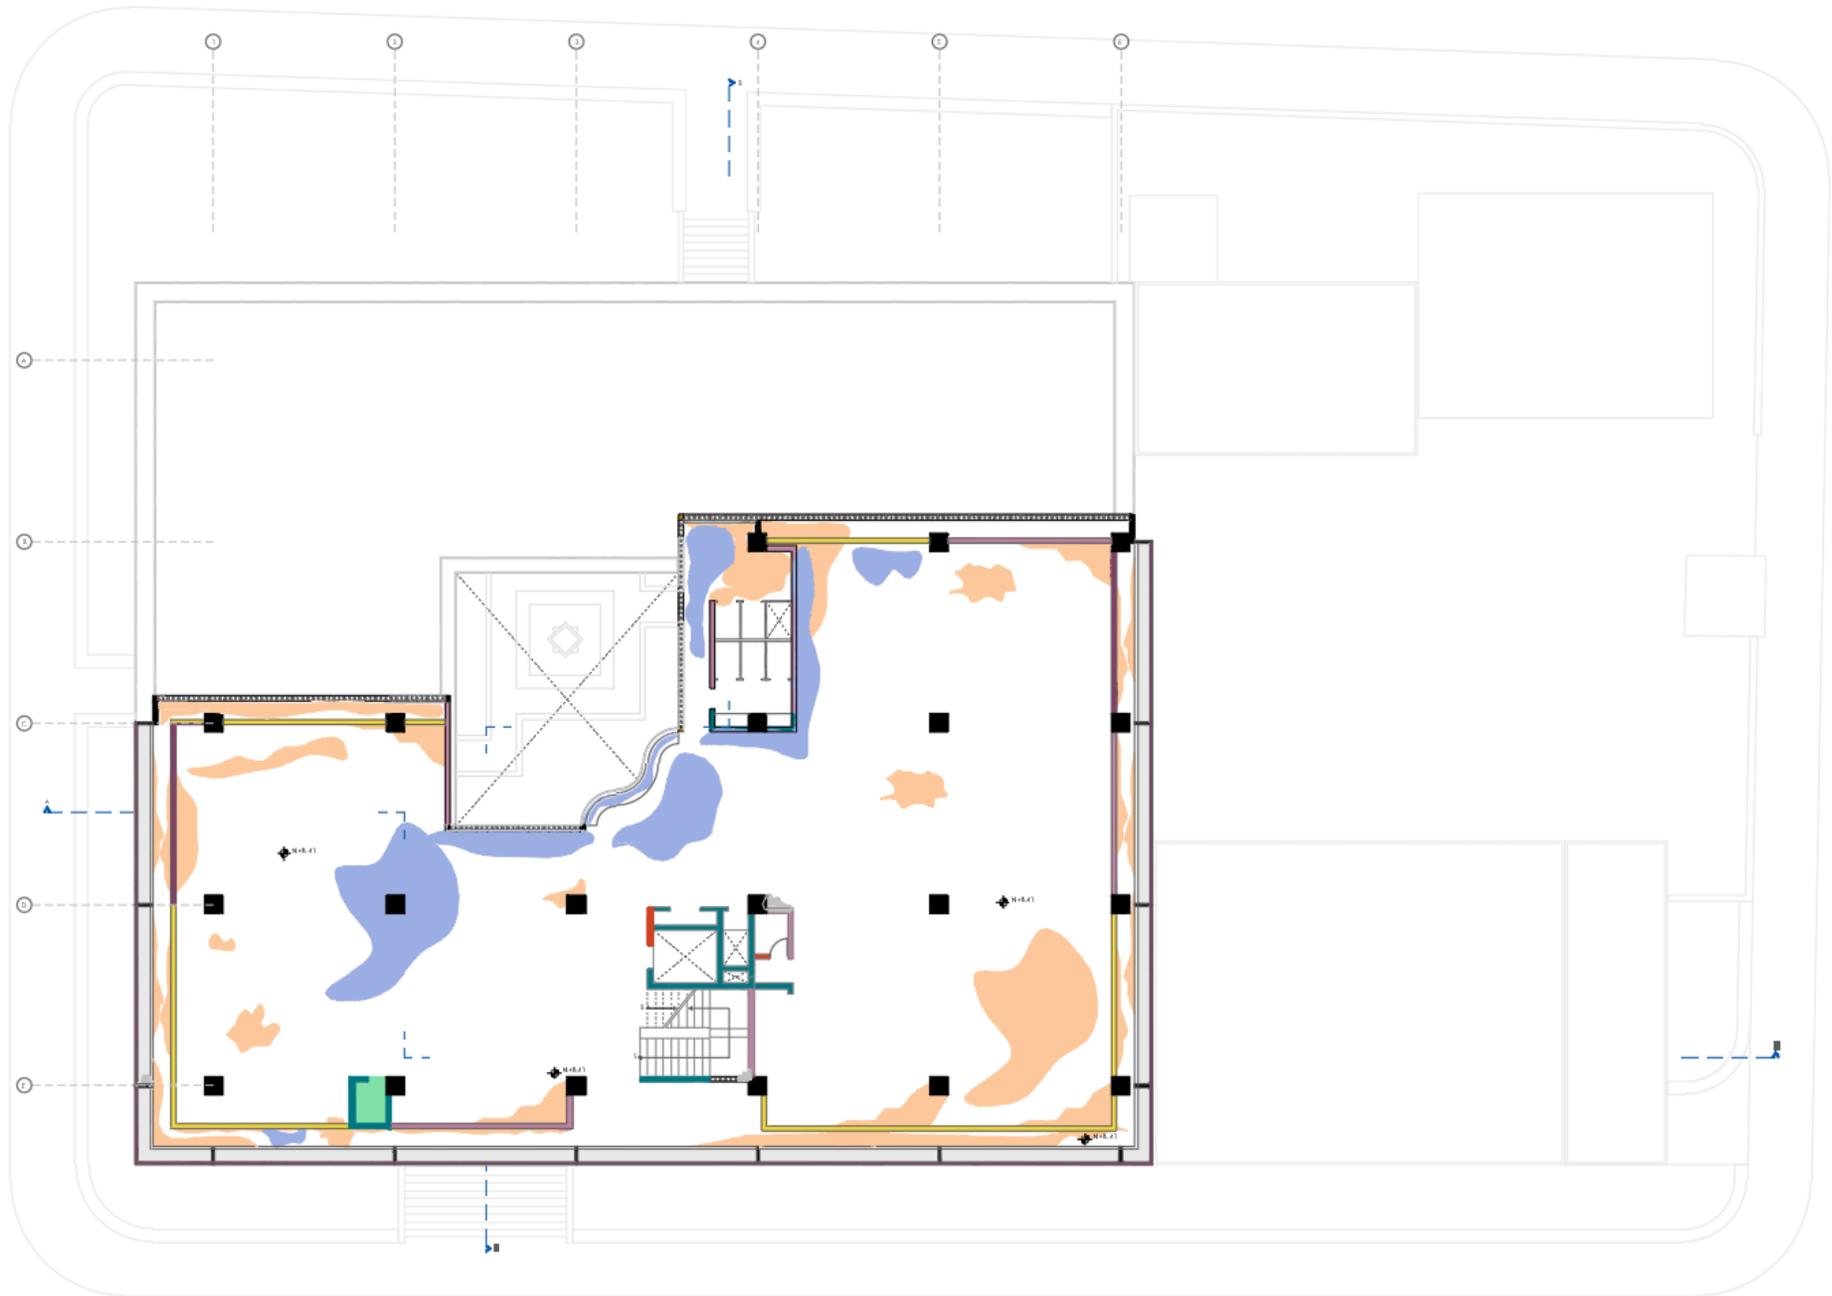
| Patologías de planta alta 1. Elaboración propia, 2021.
